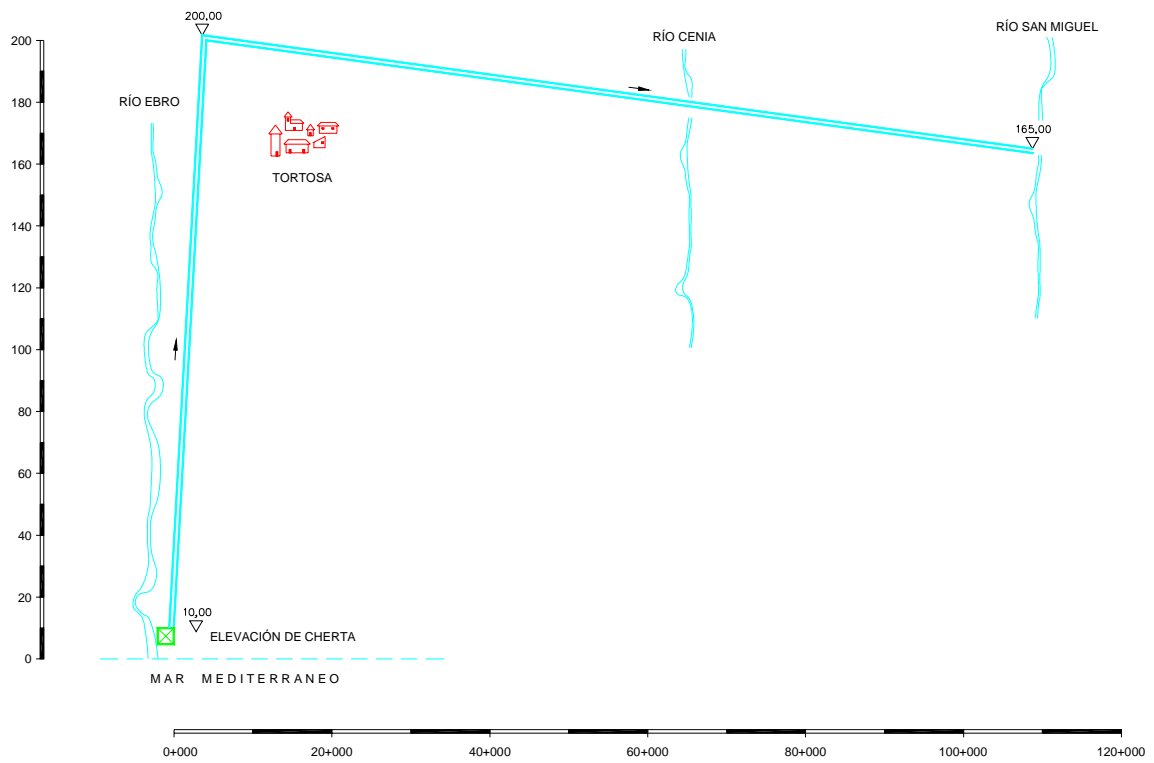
Conducción Ebro-Castellón Norte. Esquema en alzado
